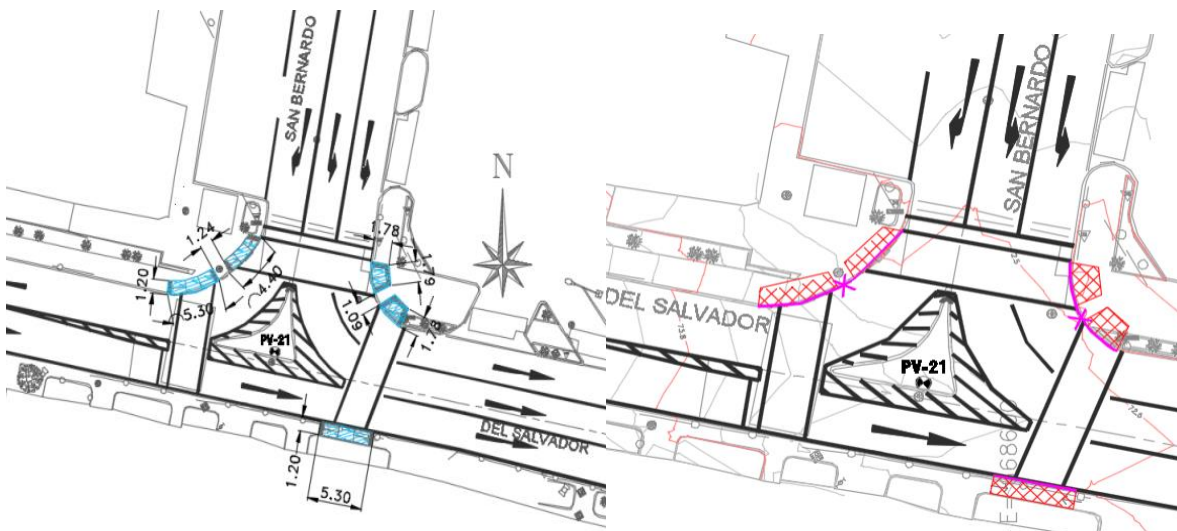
Proyecto de Pavimentación (izquierda) y Demolición (derecha) Punto 1. Fuente: Elaboración conjunta con el equipo de diseño CGM.
